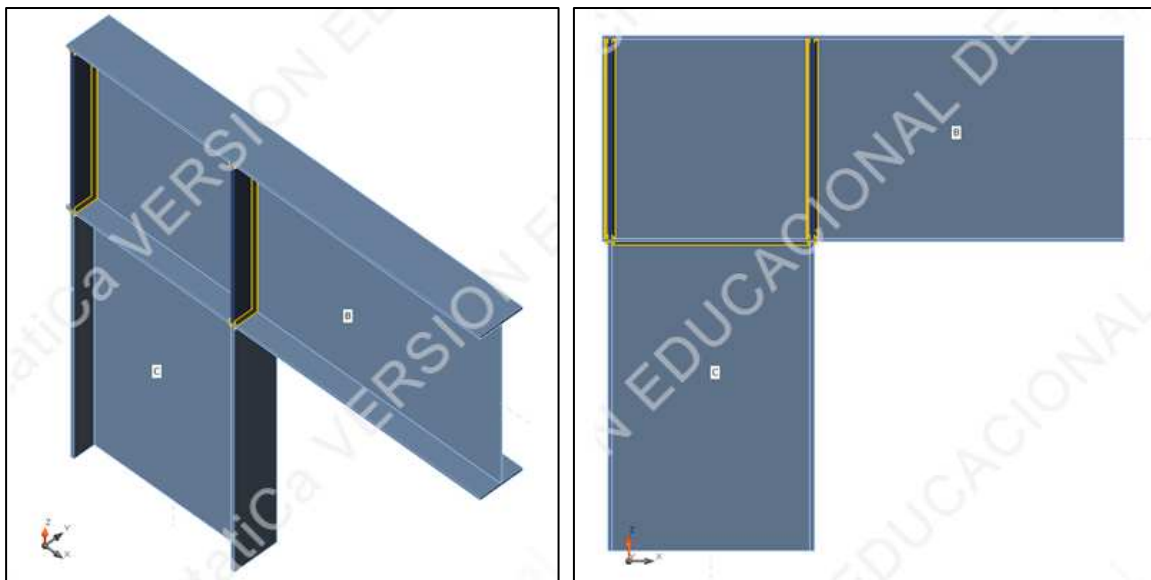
Modelo de unión soldada con rigidizadores. Fuente: Autor.
